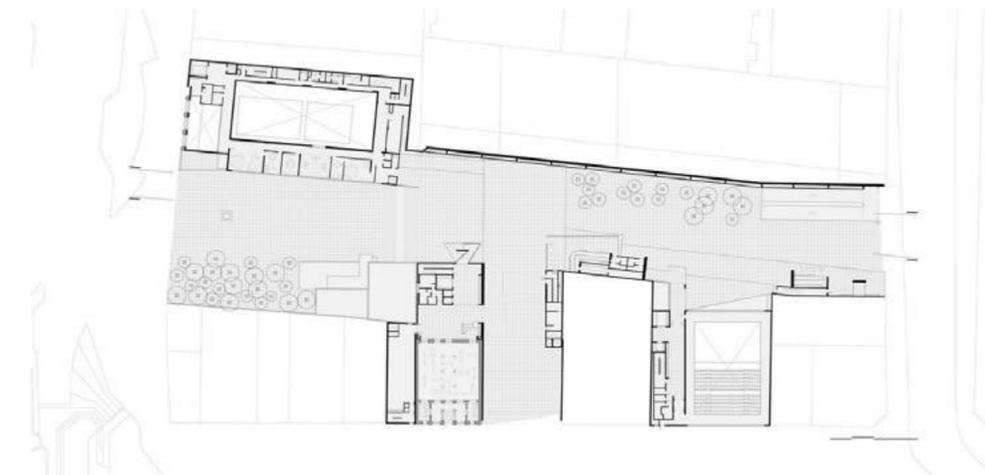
Planta pavimento térreo / Praça das Artes. Fonte: Archdaily
